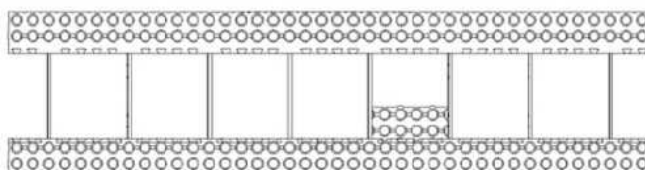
Colocação de elemento de fecho, na face interior do elemento, para criar uma ranhura, sem interrupção do núcleo de betão (ARGISOL, 2010).
